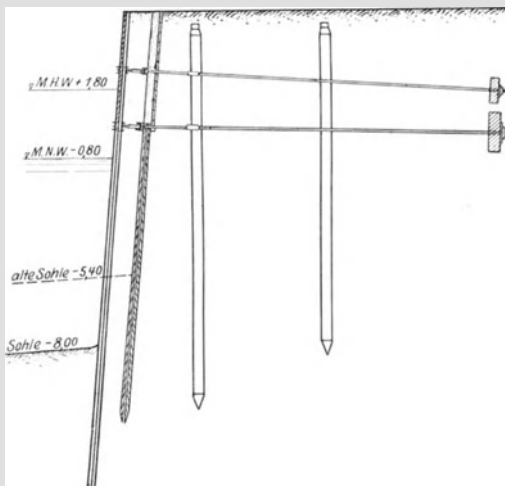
Bollwerk Vegesack. Larssen. Spundwand mit aufgesetzten Eisenbetonplatten. Die Larssenwand wurde bei der Hafentiefening vor das Holzbollwerk gerammt. Maßstab 1 : 290.
